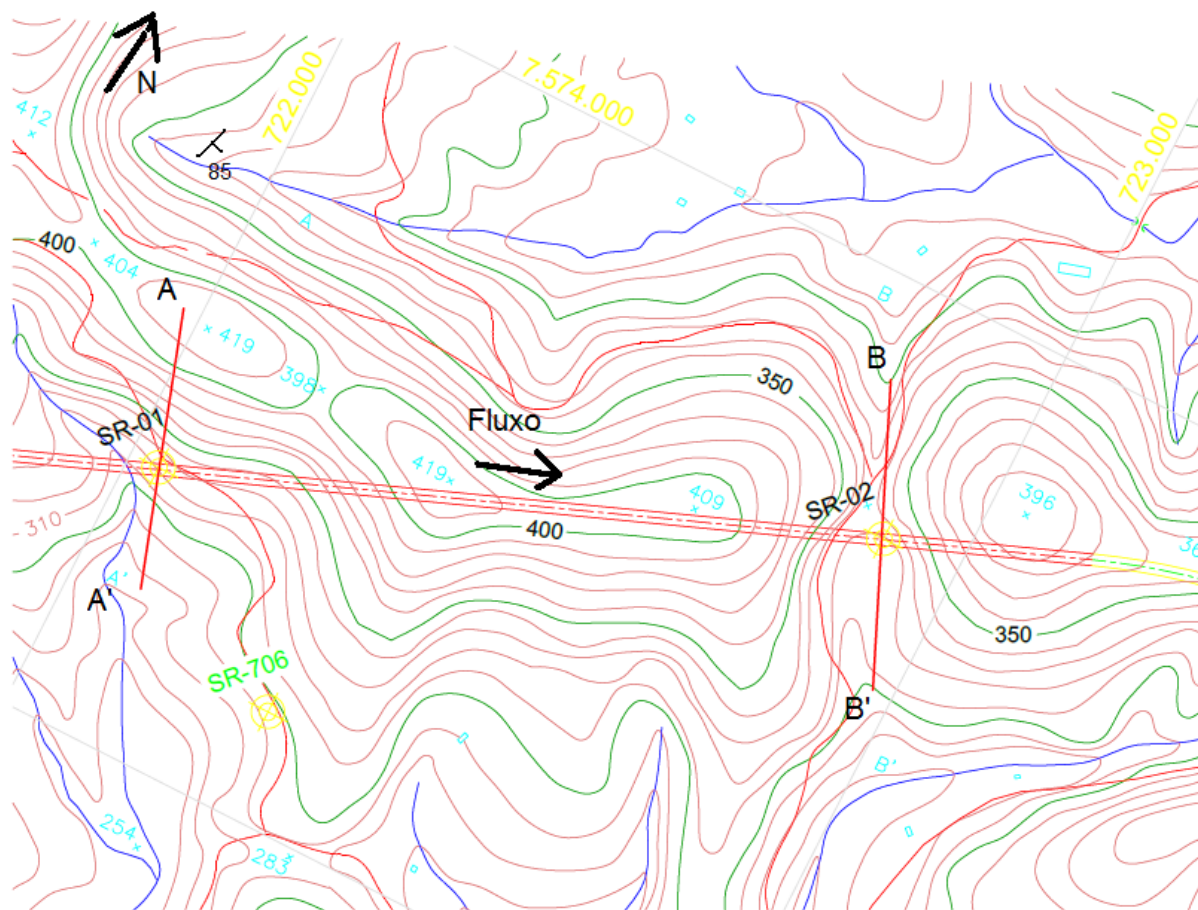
Planta topográfica com secções A-A' e B-B' realizadas no Túnel 3
